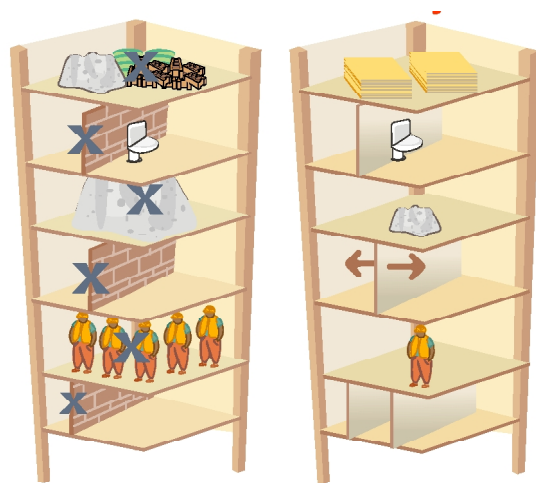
Ligereza de un sistema constructivo en seco vs un sistema constructivo húmedo
